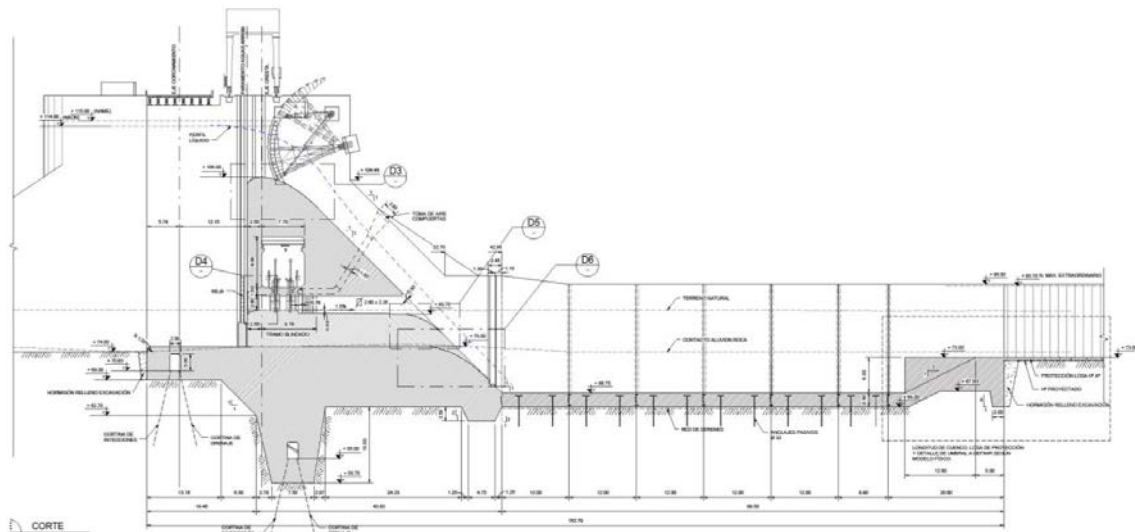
JC - Sección transversal del vertedero (Fuente: Elaboración propia)
